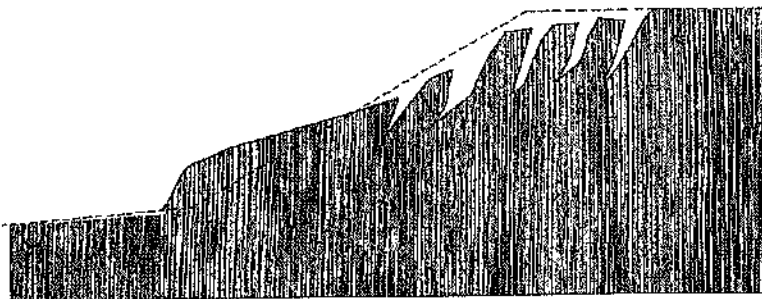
釧路空港南東側の盛土被災状況断面図 (B-B断面)
